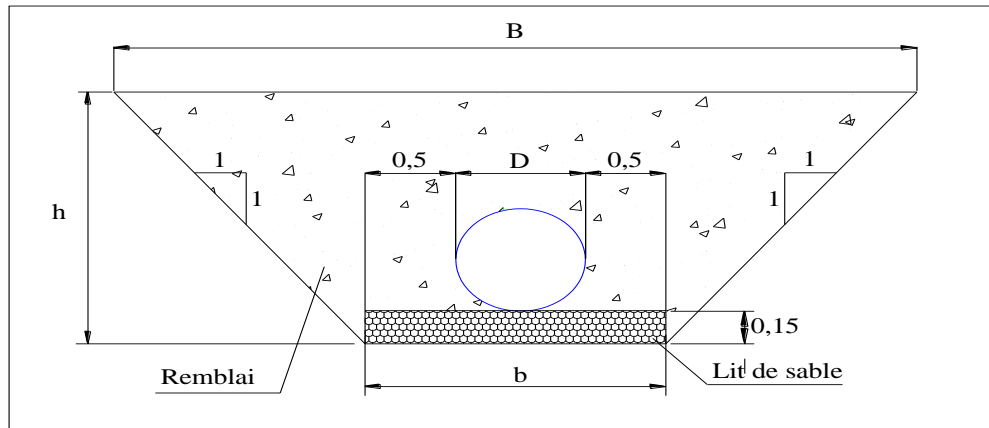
Coupes en travers de la tranchée de la conduite
